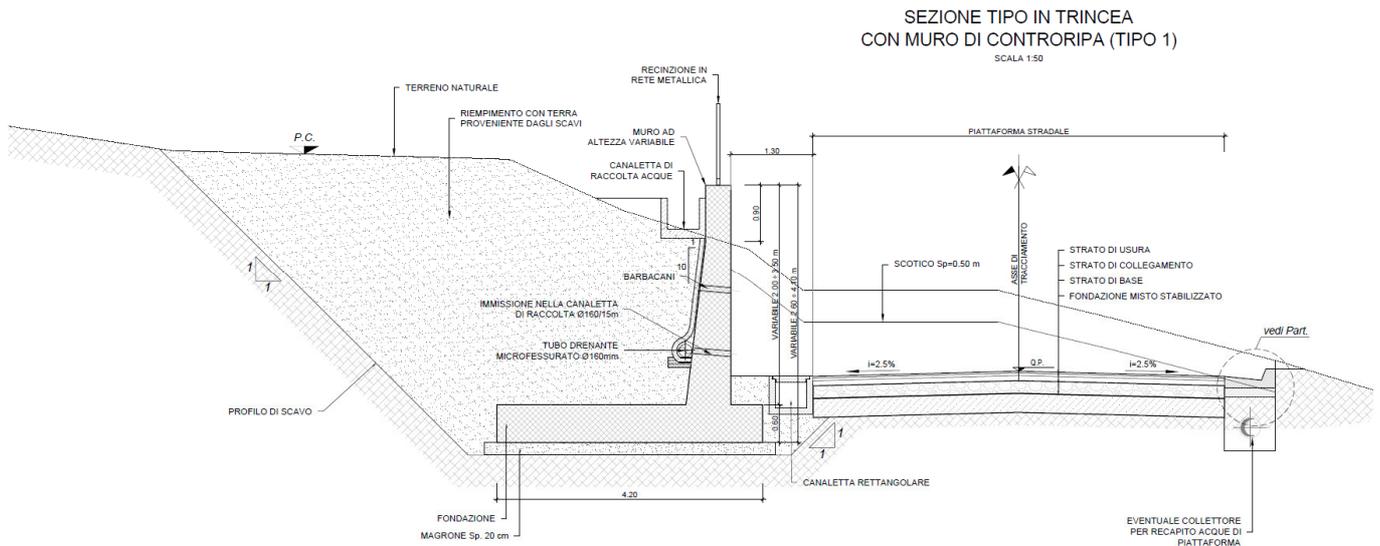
Sezione tipo in trincea con muro di controripa (tipo 1)
